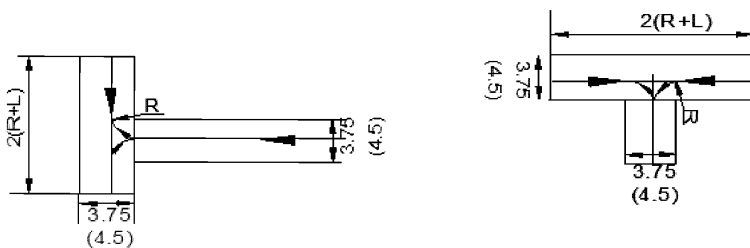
Разворотные площадки для разворота задним ходом:
